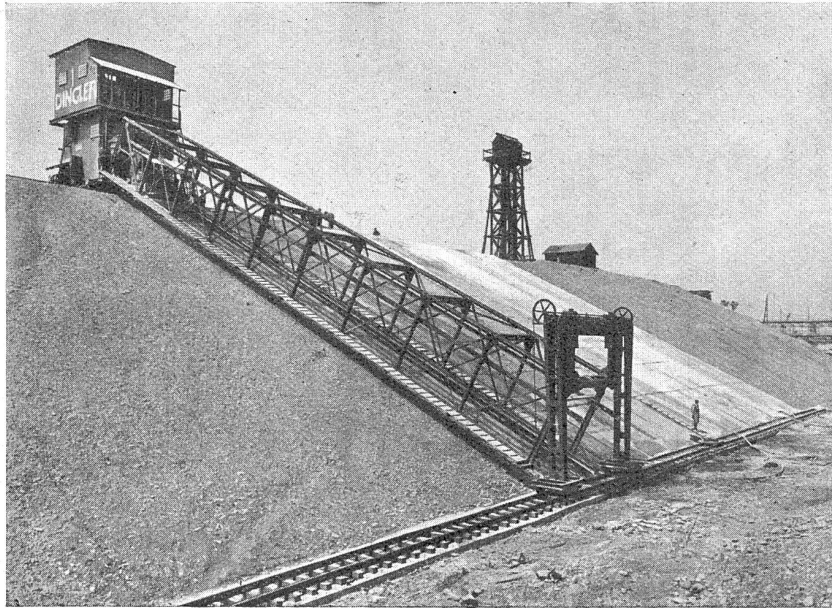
Installation zur Betonierung der Kanalböschungen.
